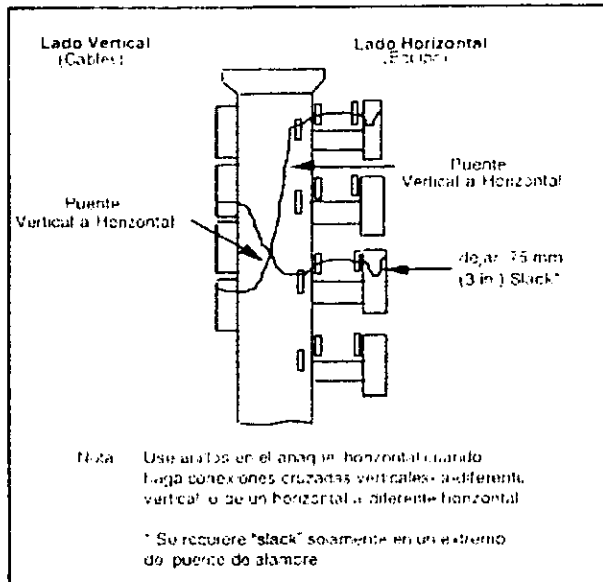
Sección Transversal de MC, Arreglo Montado en Estructura Armada Tipo RackTM
